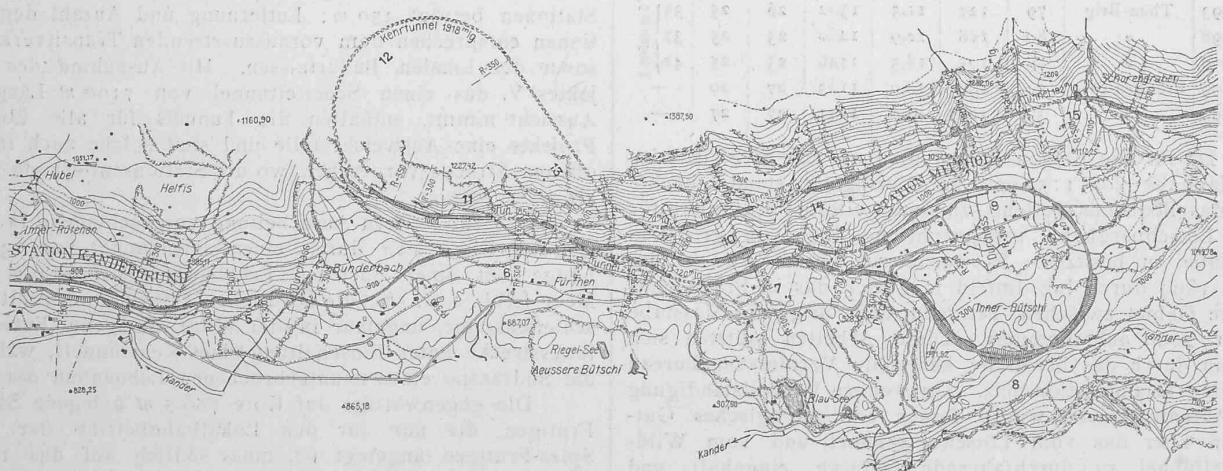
Projekt I. Entwicklung oberhalb der Station Kandergrund. — Lageplan. — Maßstab 1 : 25 000.
